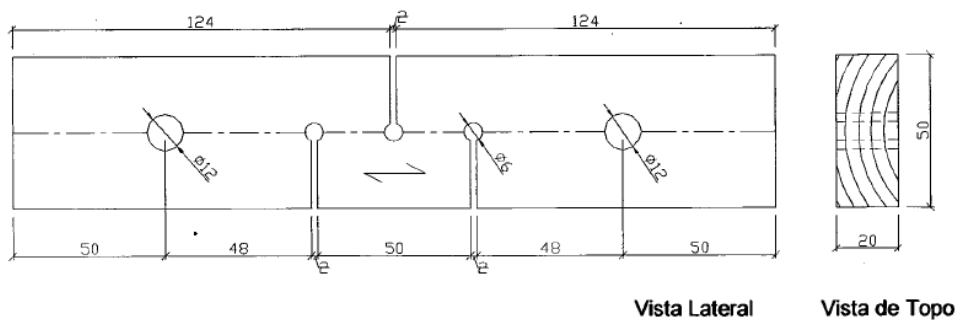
LEE/Ufsc Modificado (Dimensões em mm)
